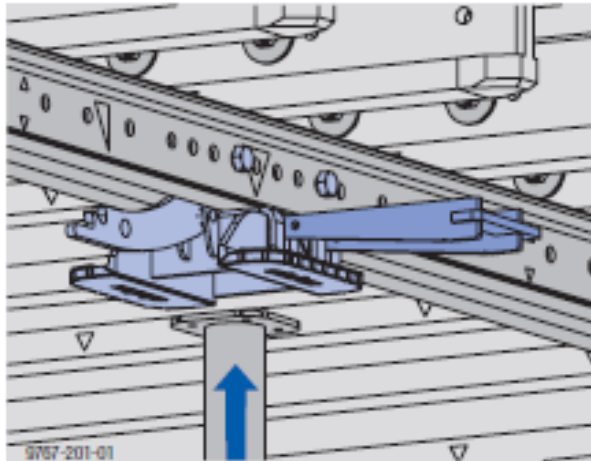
Entramado de vigas primarias y secundarias.2016.Doka
